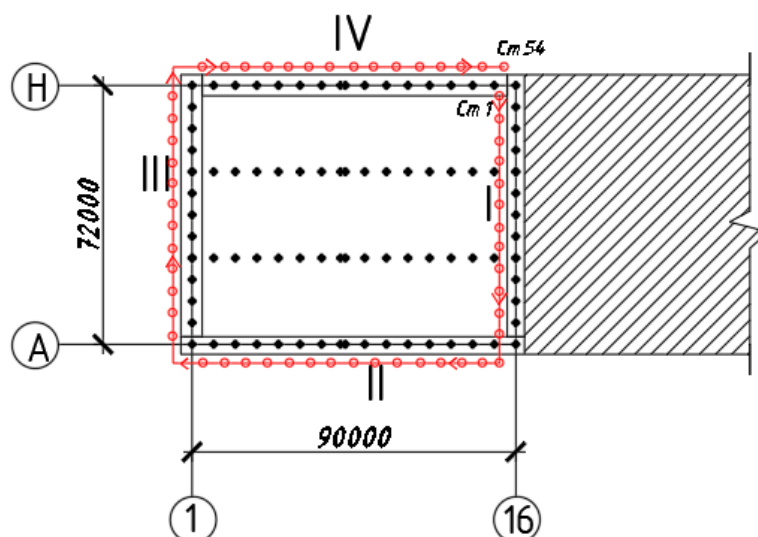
Разбивка на захватки монтажа стеновых панелей, фундаментных балок и колонн фахверка промышленного здания.
